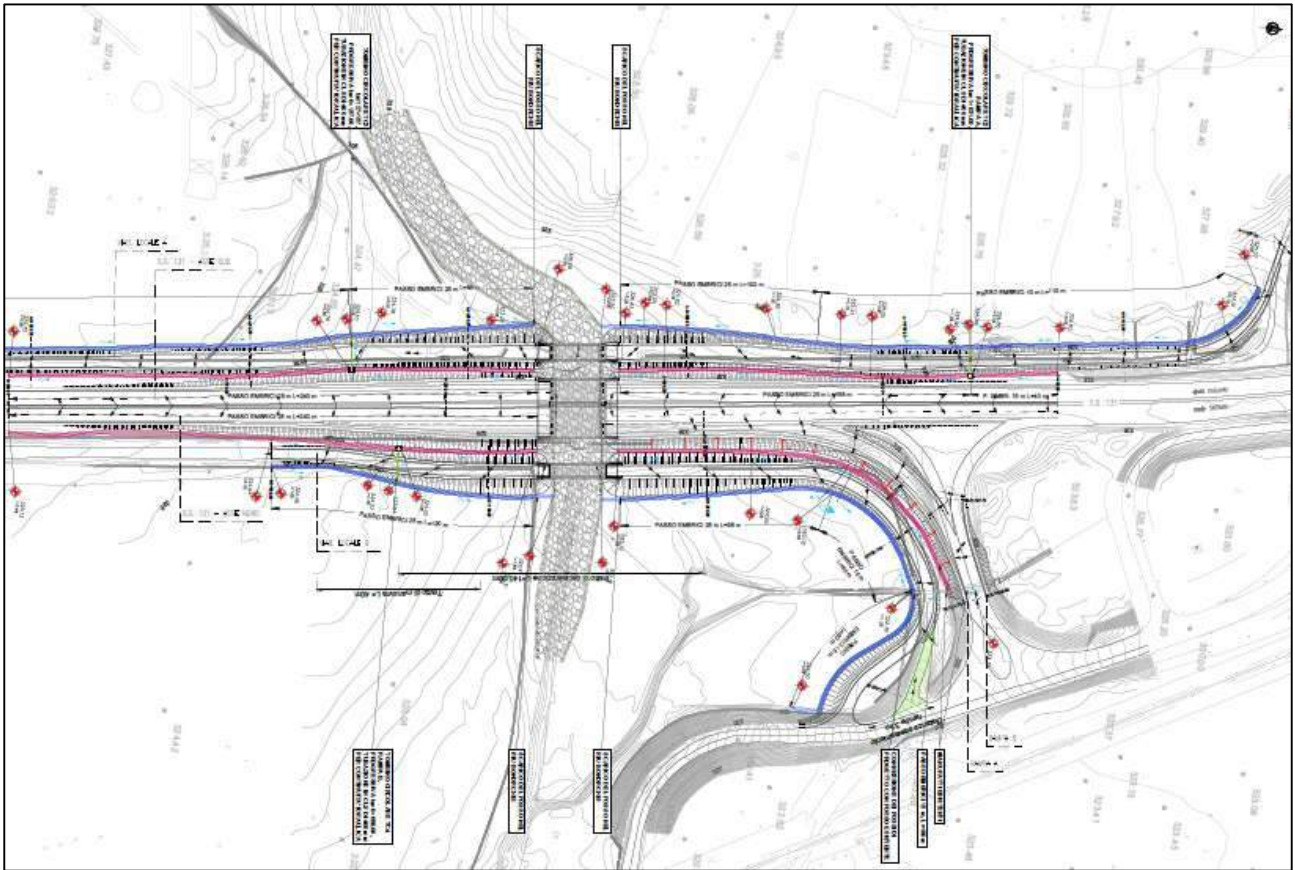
Stralcio planimetrico intervento S21-Risoluzione accessi al km 127+000, inquadramento 2/2
